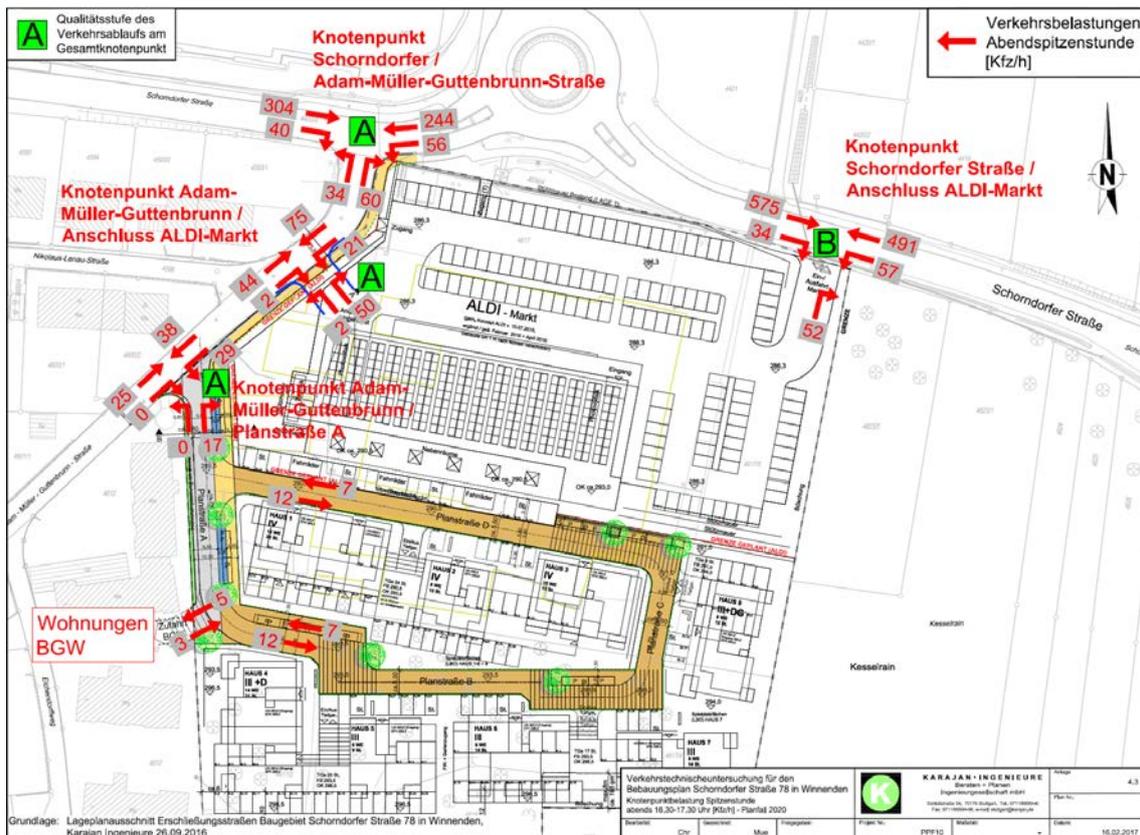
Verkehrstechnische Untersuchung, Knotenpunktbelastung Spitzenstunde abends 16:30 - 17:30 Uhr, Kfz/h, Planfall 2020, KARAJAN Ingenieure GmbH, Stuttgart, 16.02.2017
